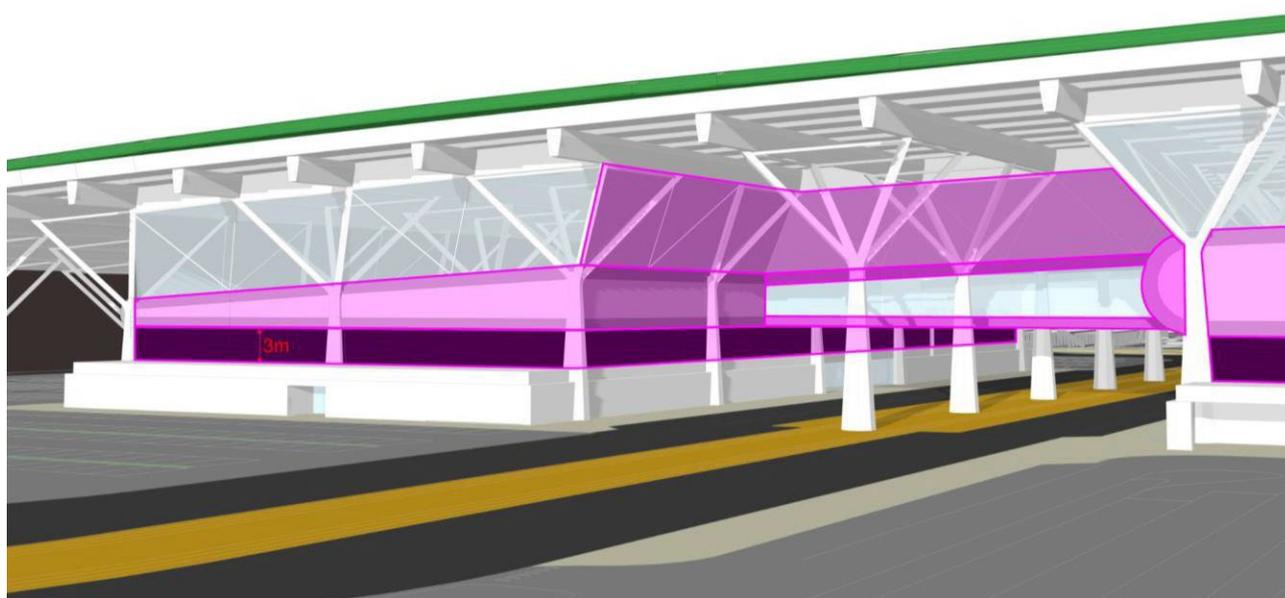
EWS-201: Pannello sandwich prefabbricato. Mark up della facciata.
